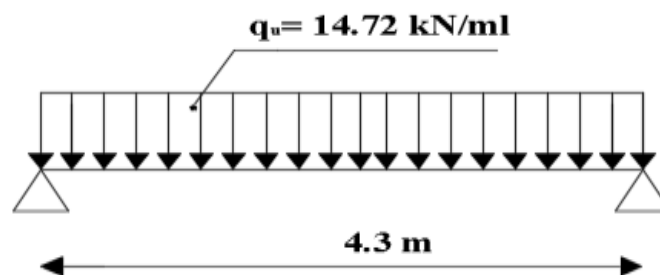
Schéma statique de la poutre de chaînage à l'ELU.
